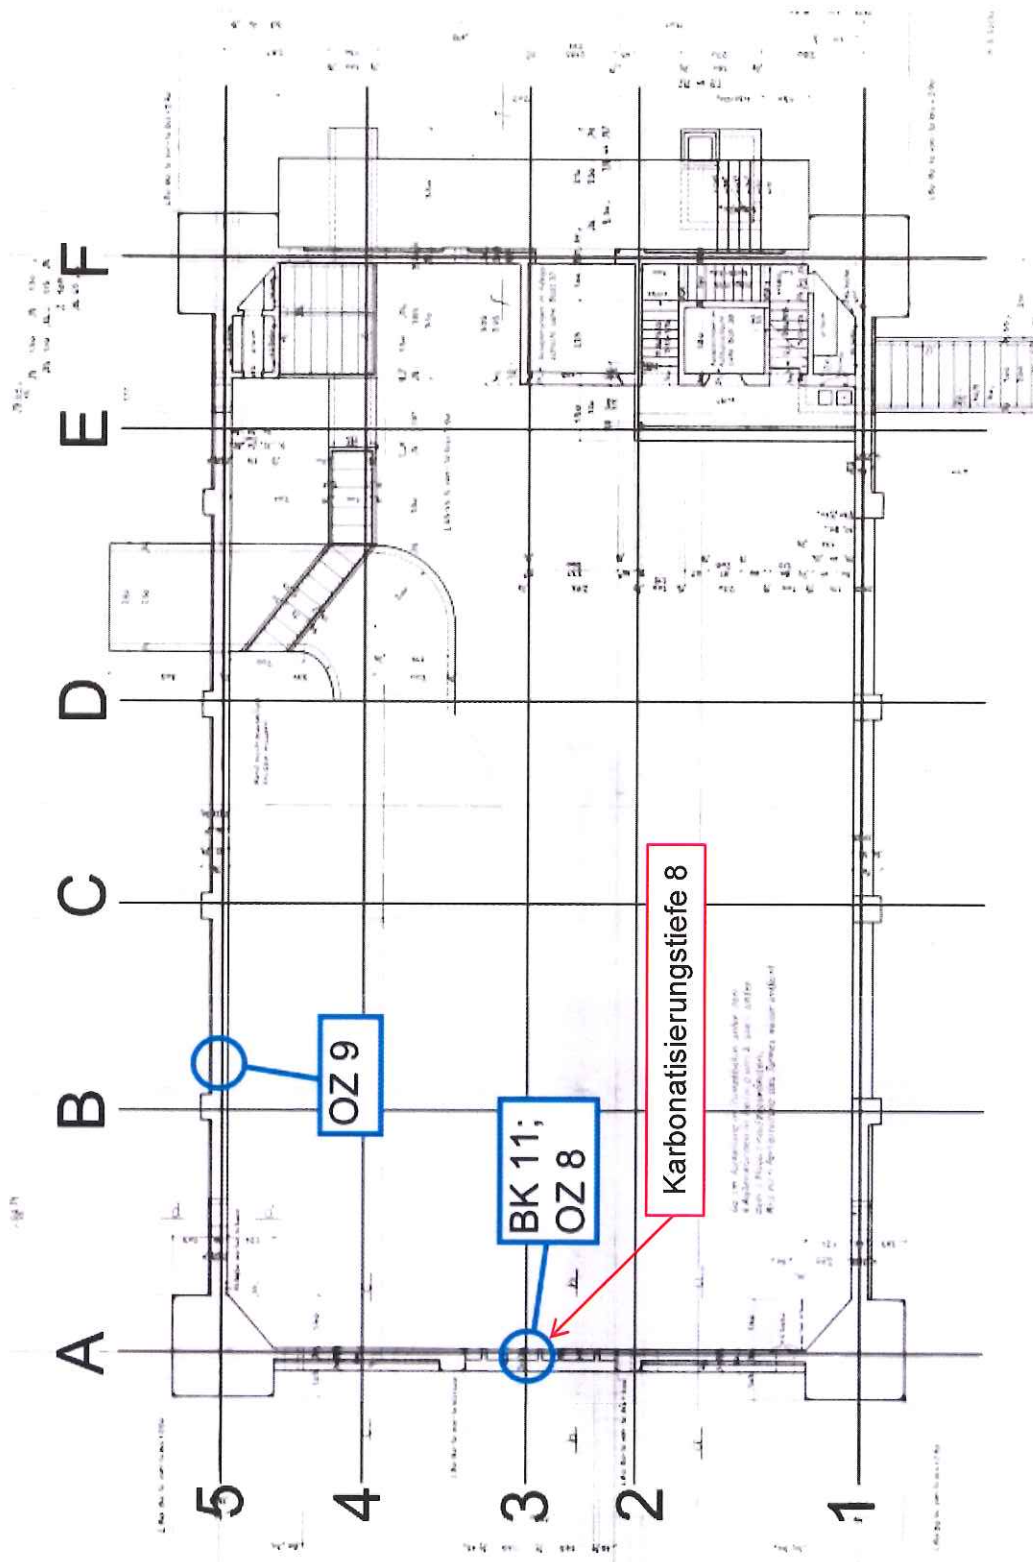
Grundriss Bühne 1 mit Entnahmestellen
